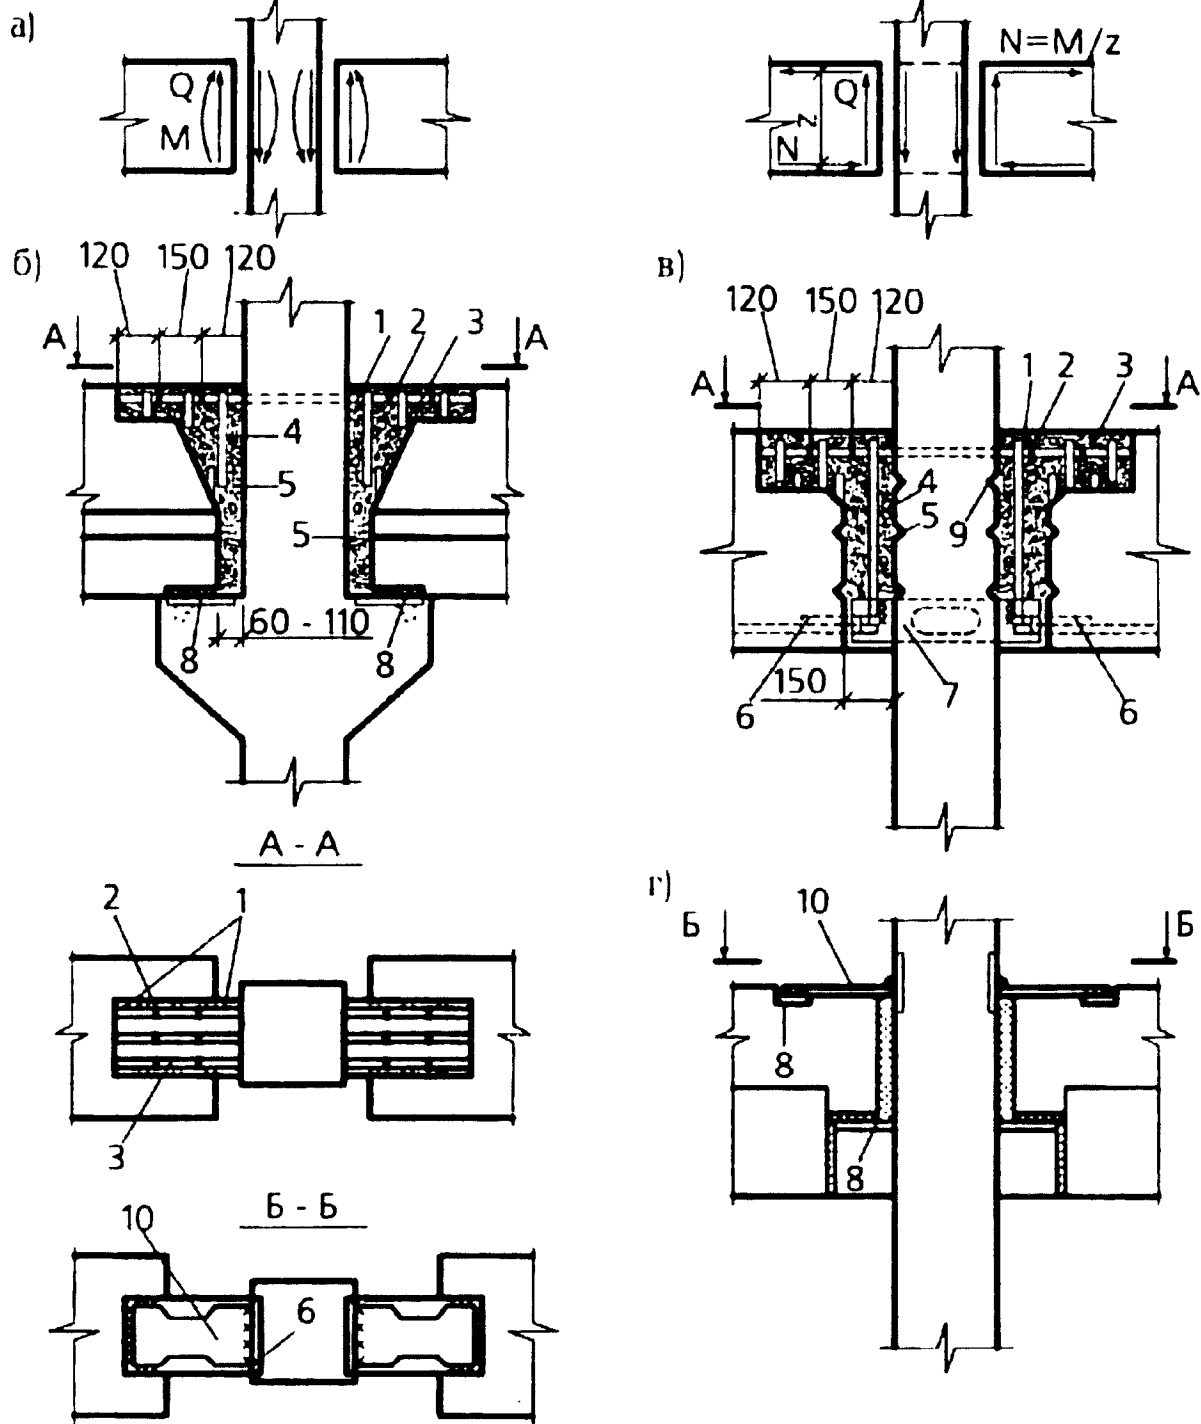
Конструкции стыков сборного ригеля с колонной: а - усилия, действующие в стыке; б - жесткий стык на консолях; в - жесткий стык бесконсольный; г - скрытый стык на консолях; 1 - арматурные выпуски из ригеля и колонны; 2 - ванная сварка; 3 - вставка арматуры; 4 - поперечные стержни, привариваемые при монтаже; 5 - бетон замоноличивания; 6 - усиленный арматурный выпуск из ригеля; 7 - опорный столик из уголков с отверстием для удобства бетонирования; 8 - стальные закладные детали; 9 - призматические углубления для образования бетонных шпонок; 10 - фигурная деталь «рыбка», привариваемая на монтаже
